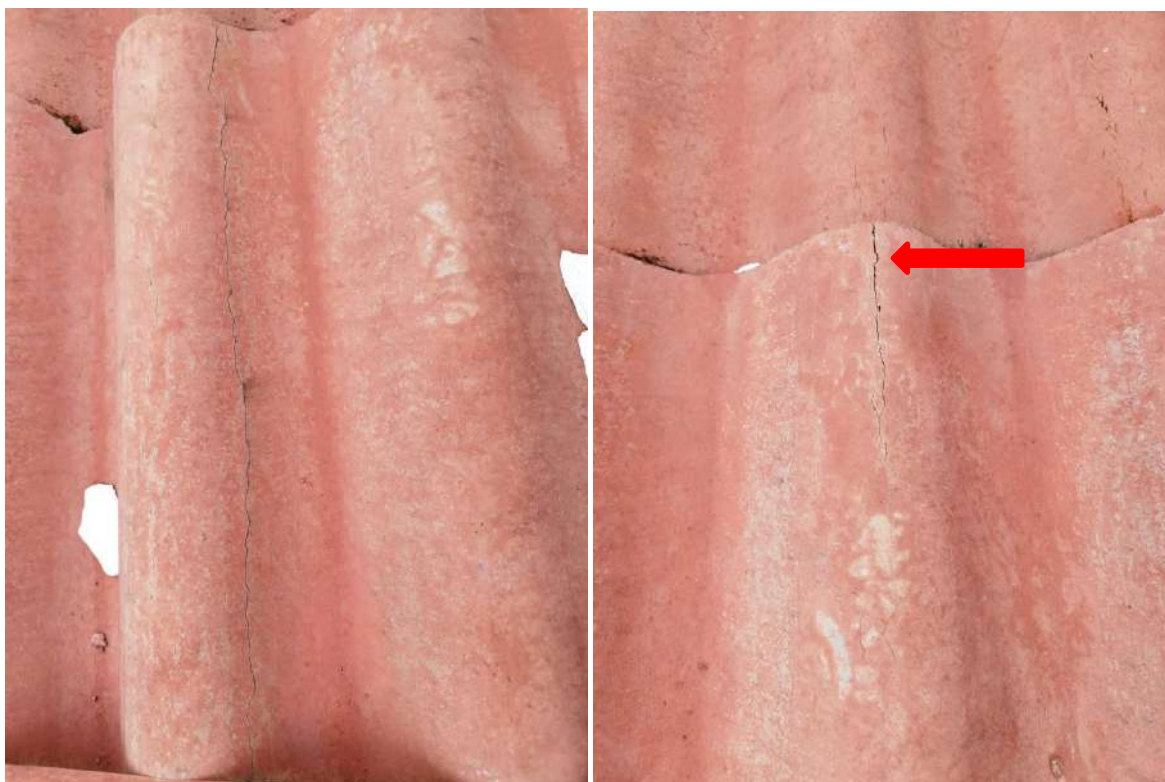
e 17 – Destaque para o telhado do pavimento superior com as telhas quebradas e trincadas.
